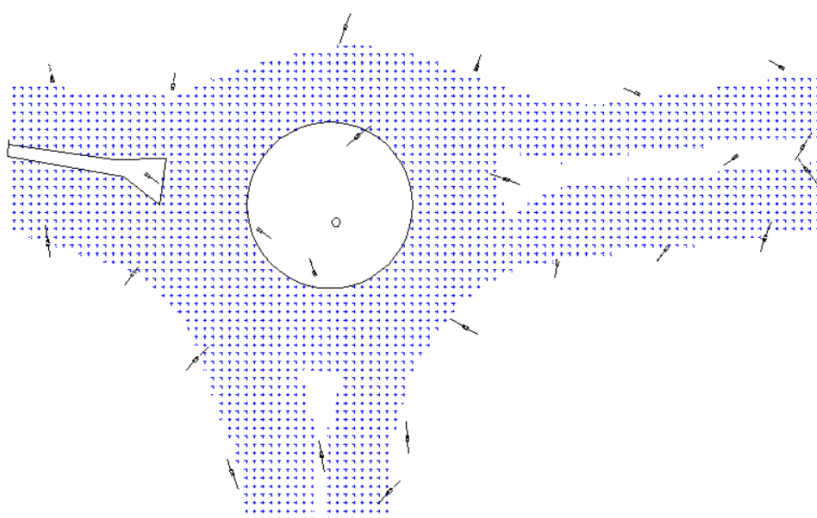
Planta da rotunda com a disposição das luminárias.
